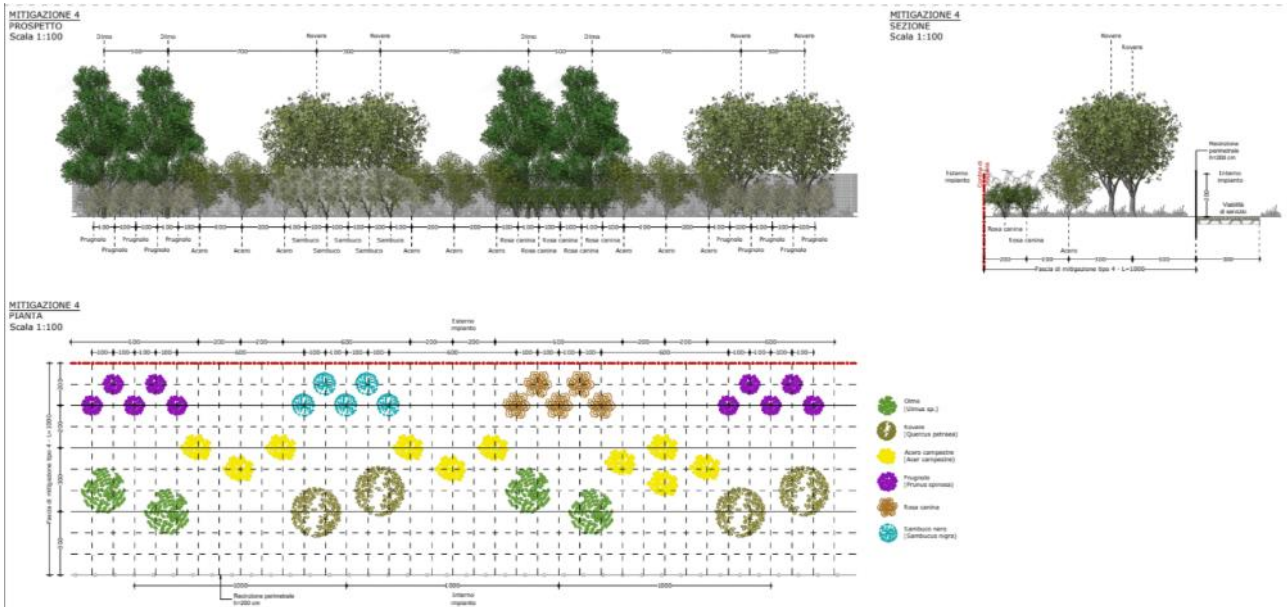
Pianta, sezione e prospetto della mitigazione di tipo 4 (da elab. di progetto)
